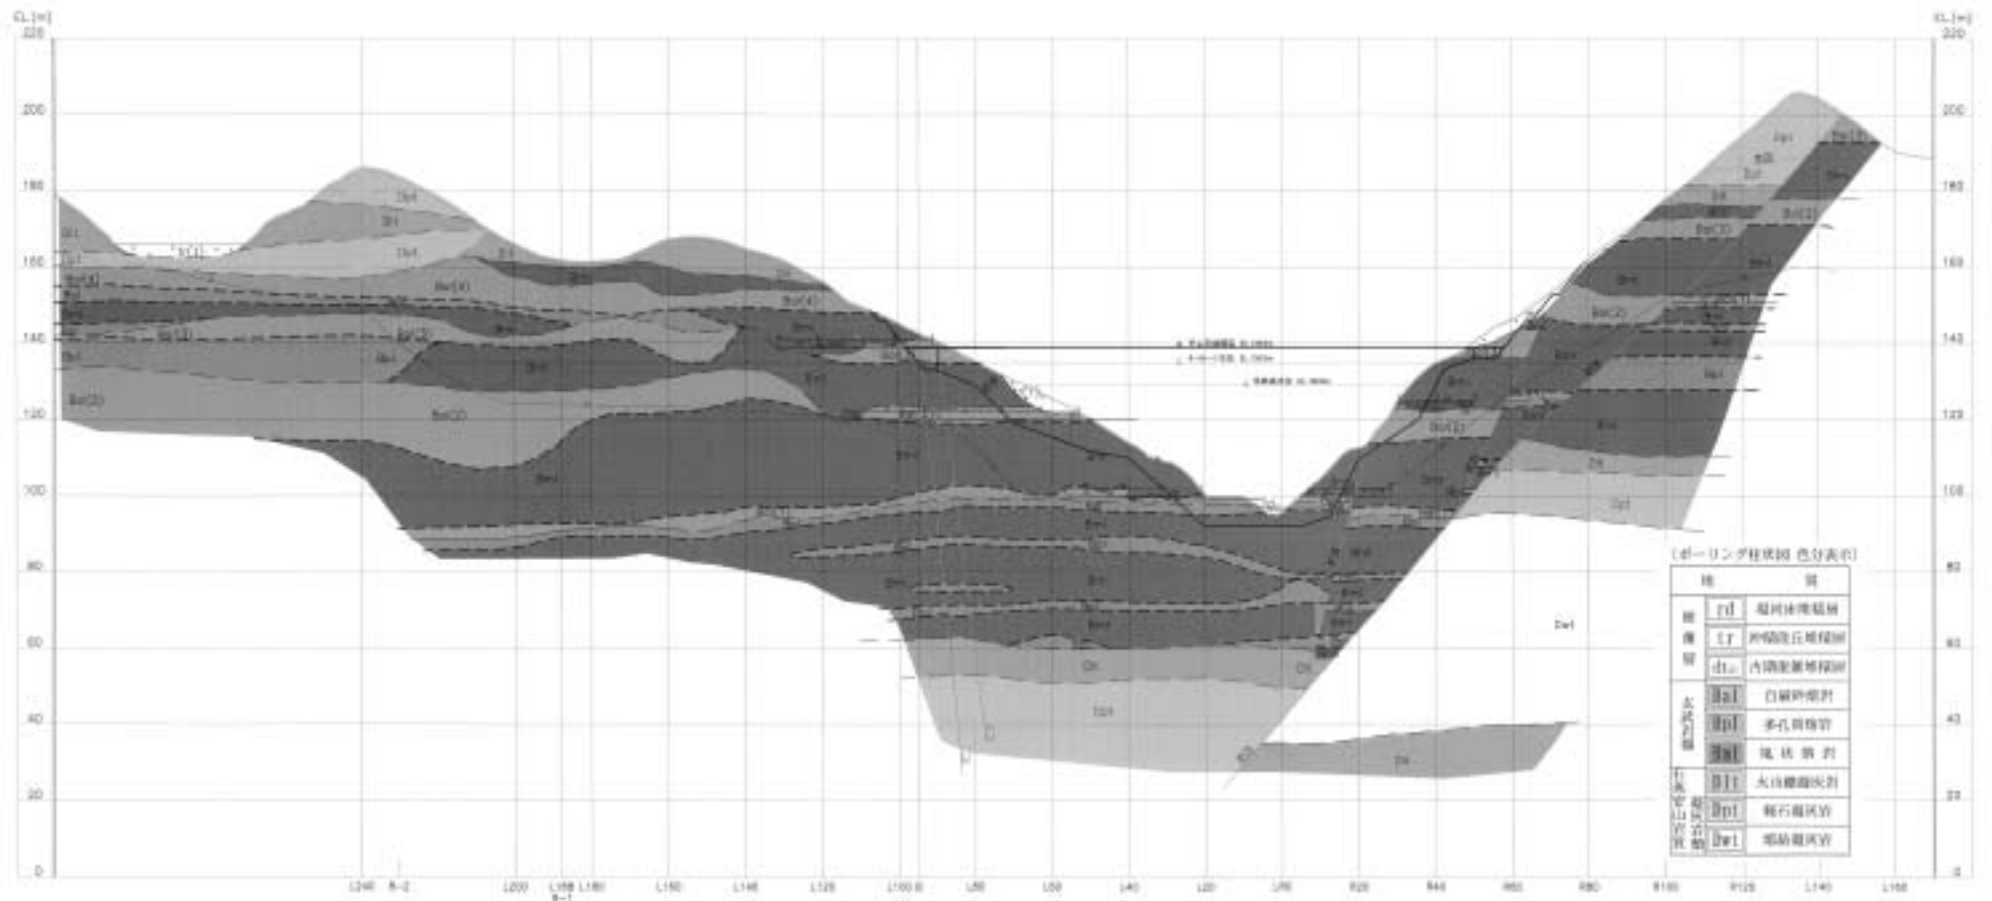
ダム軸 (UD0) 地質断面図 (S=1:1,000)
